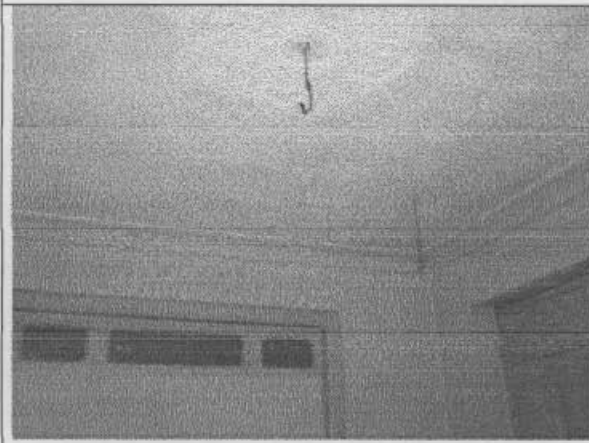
La deflexiones excesivas de los cielos rasos en algunos sectores han sido contrarrestadas con apuntalamiento temporales.
